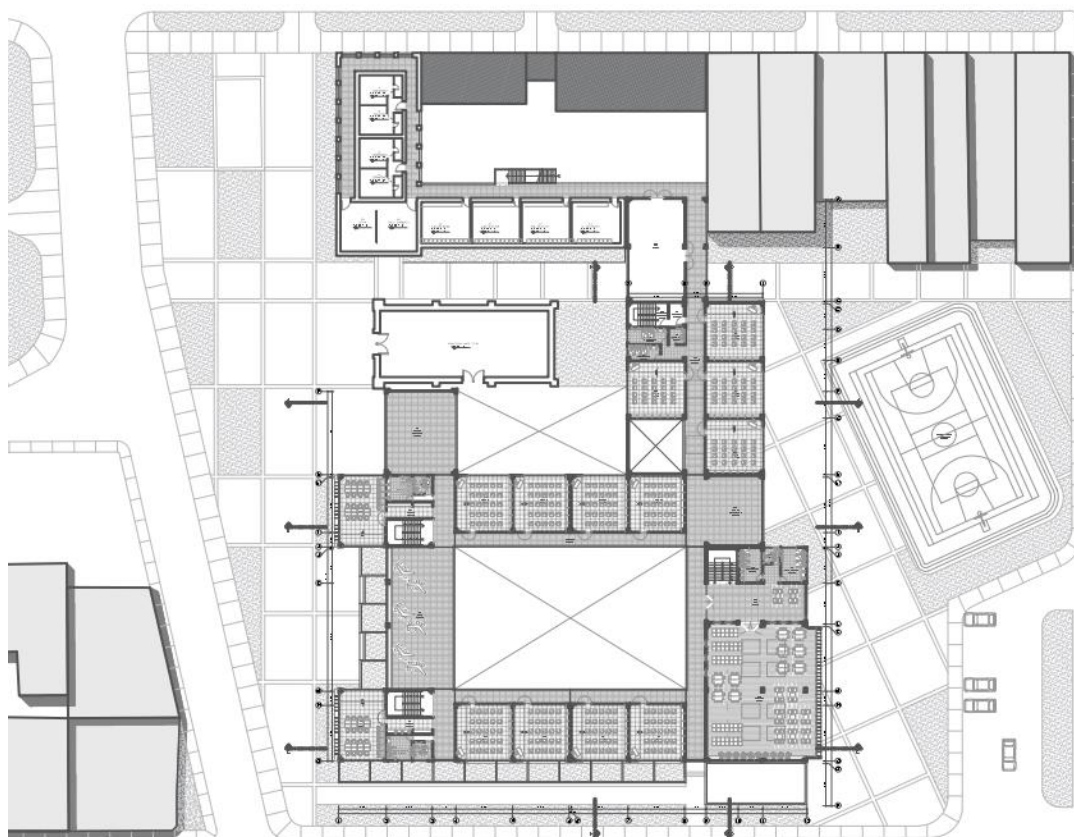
Plano segundo nivel, propuesta arquitectónica Escuela Parroquial.
